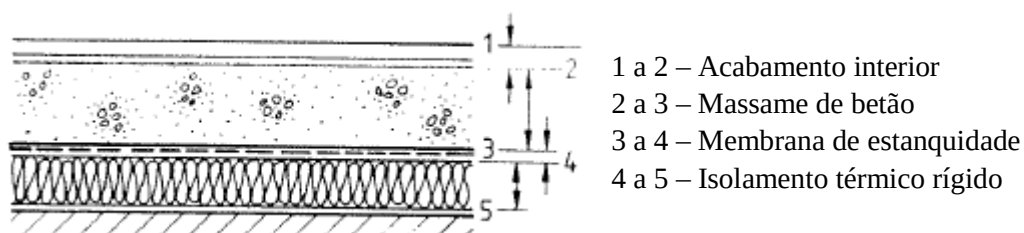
Constituição de pavimentos térreos com isolamento térmico sob o massame [2]
